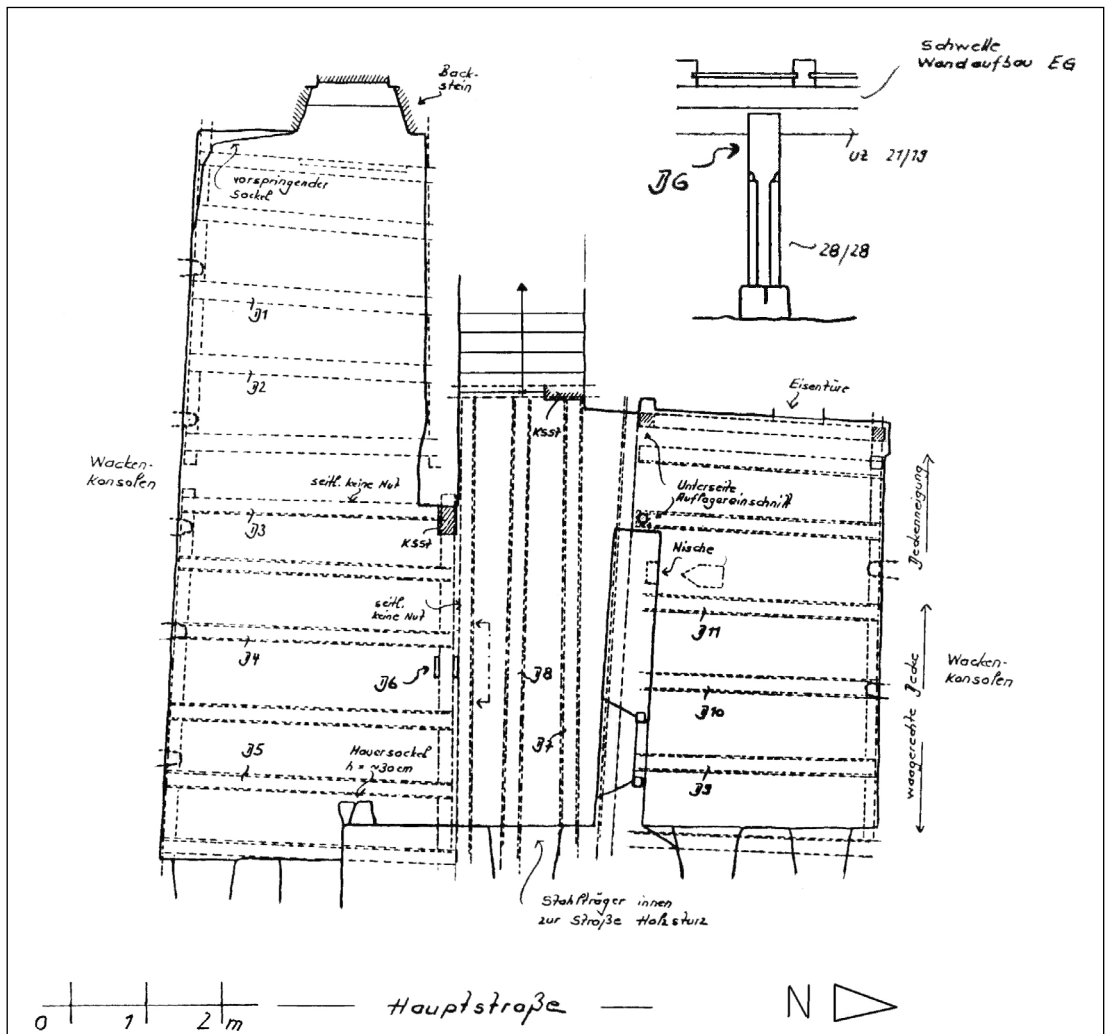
Hauptstraße 52, Grundriss Keller.
